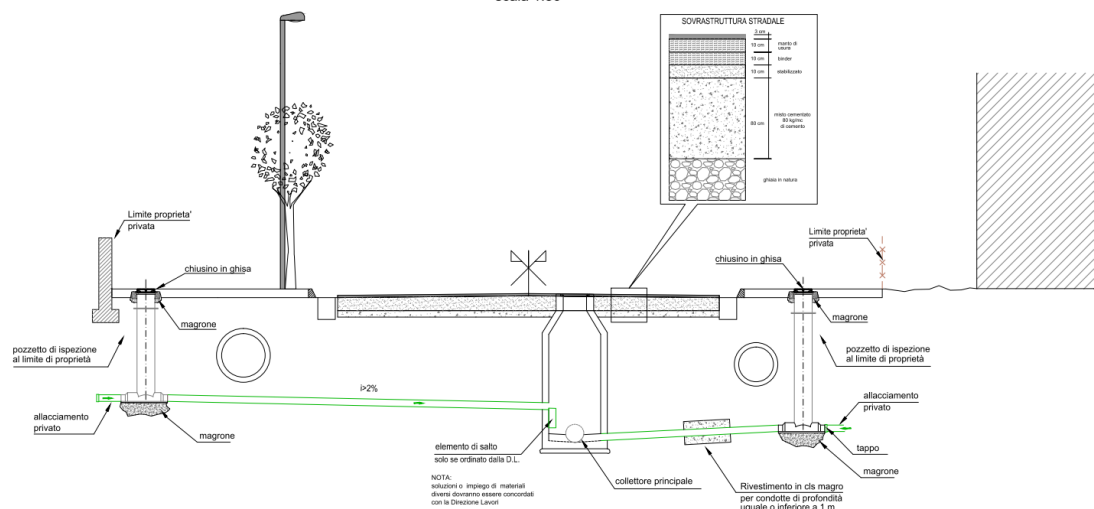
Sezione stradale tipo con fossi di guardia tombati
